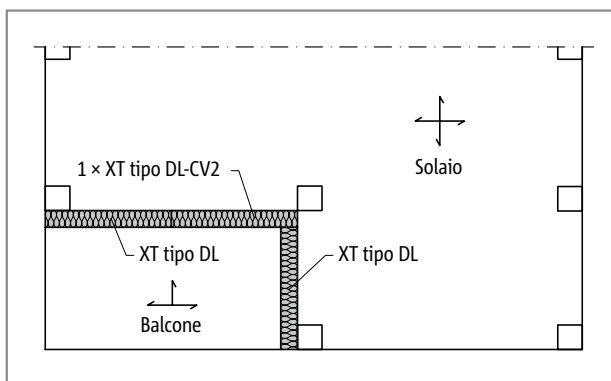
Schöck Isokorb® XT tipo DL: impiego per solai a lastra
